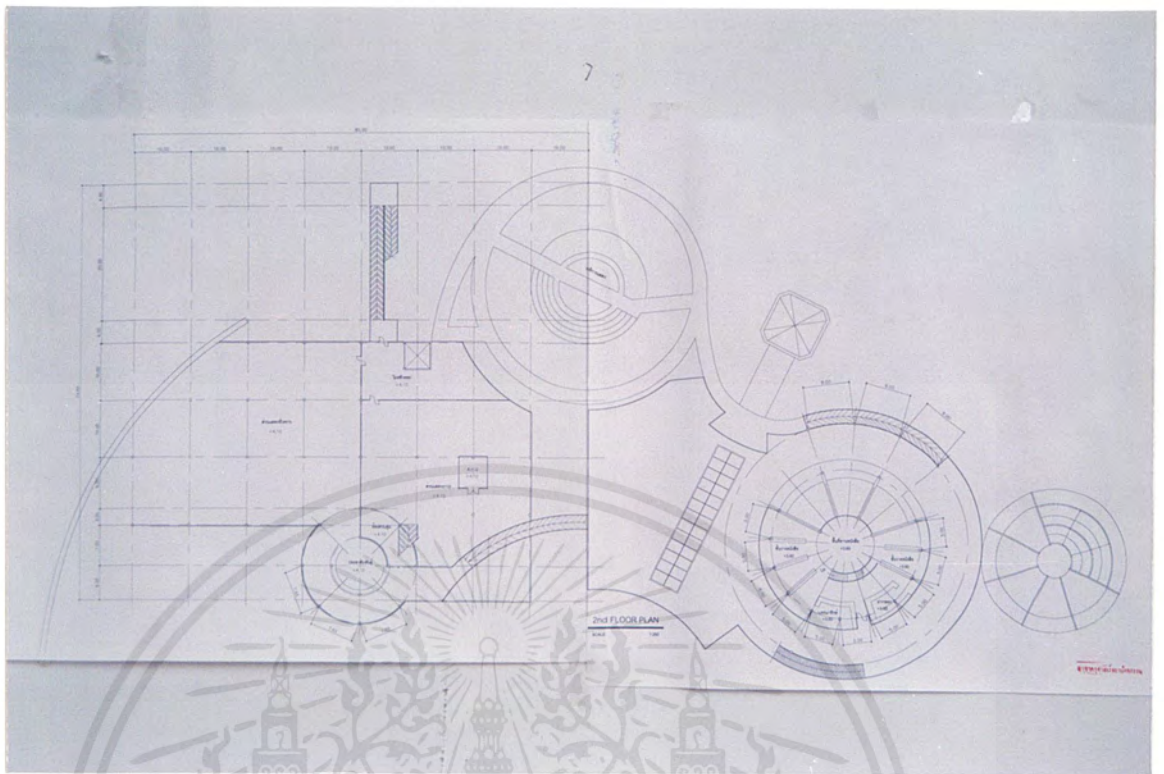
บังหลังคา (LAY - OUT PLAN)
